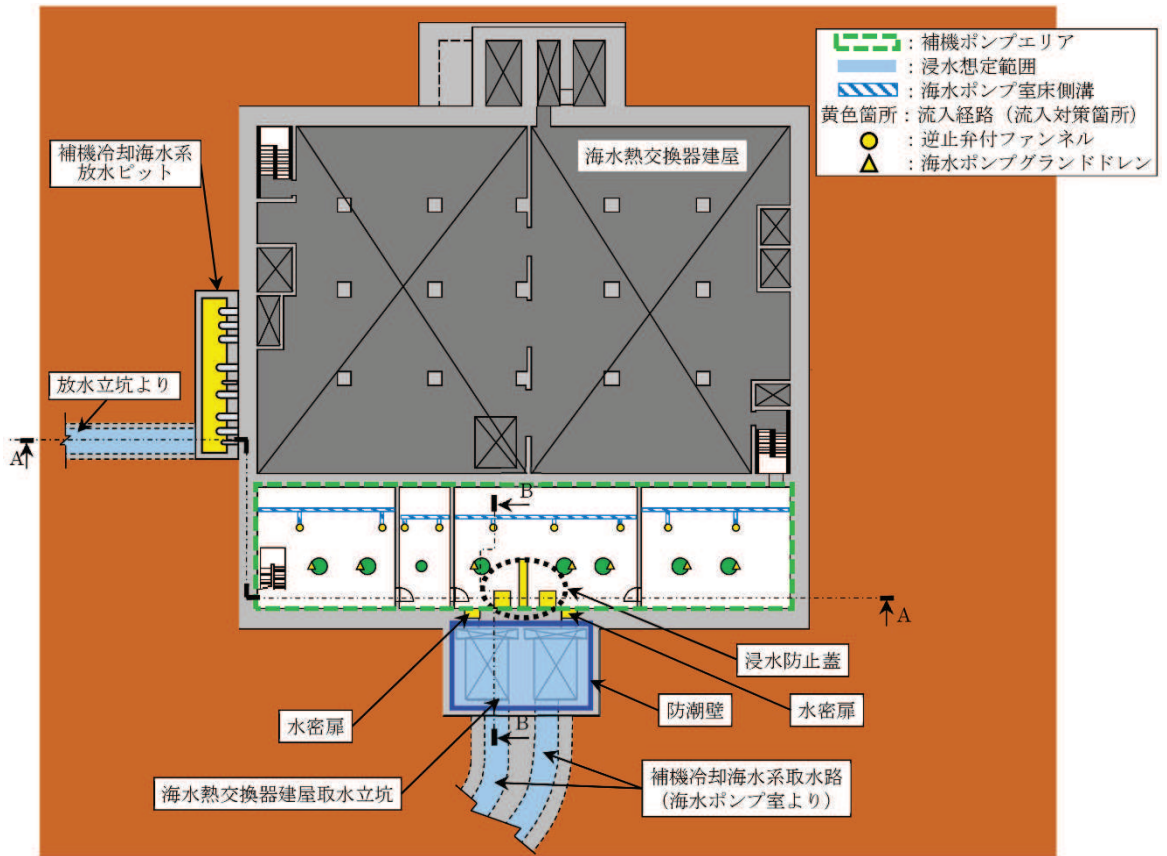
3号機 海水熱交換器建屋 流入対策配置図 (平面図)
